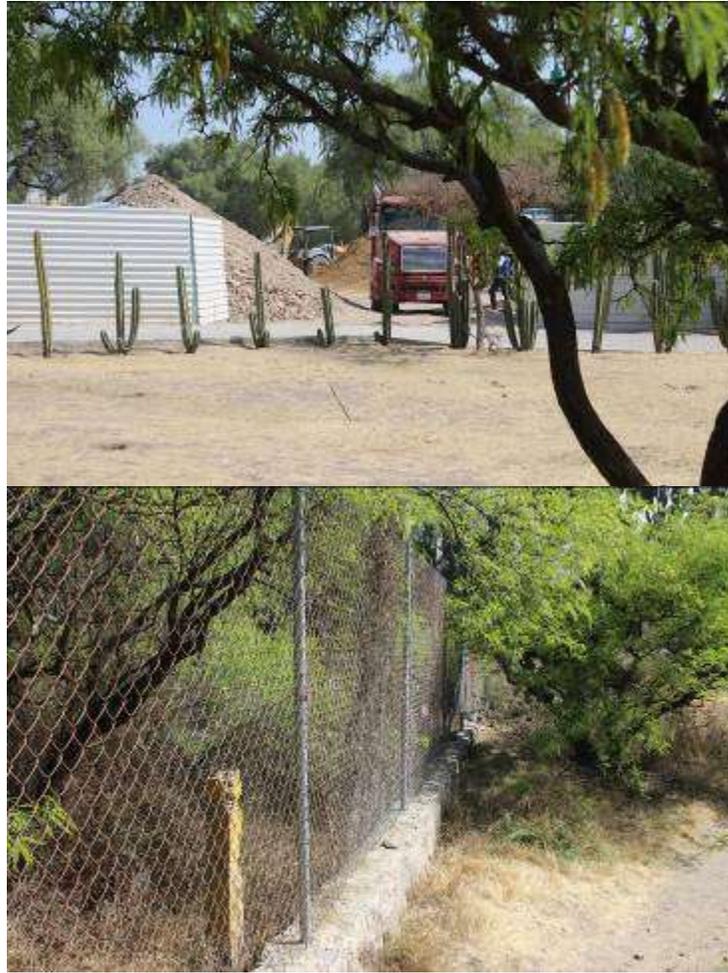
Inicio de la construcción del planetario y barda perimetral, 2020.
